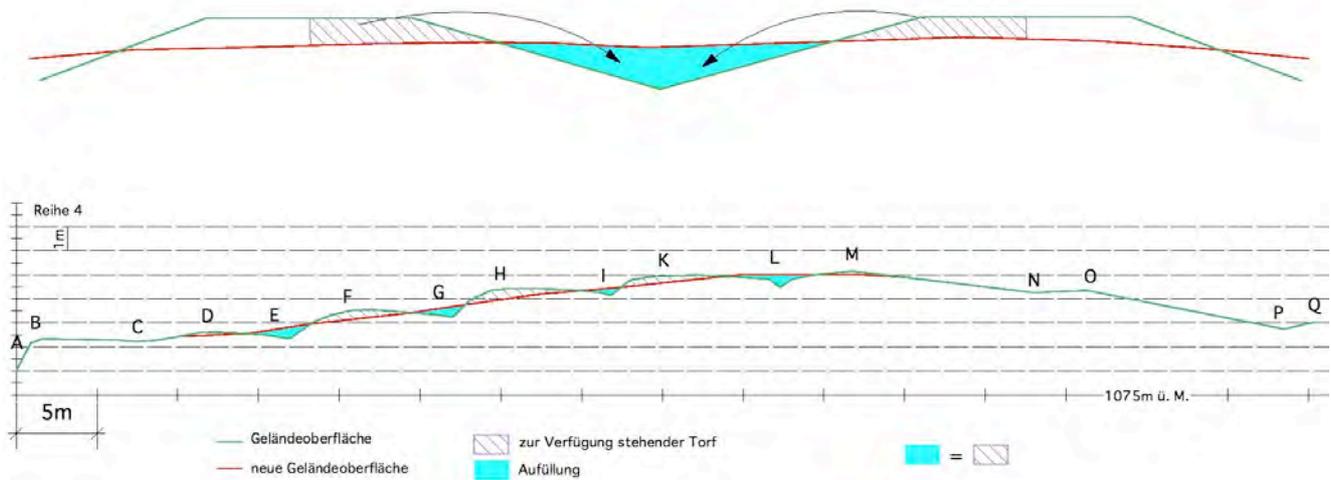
Schema Terrainanpassung mit Detailansicht (oben) und Schnitt durch Reihe 4 (überhöhte Darstellung).
